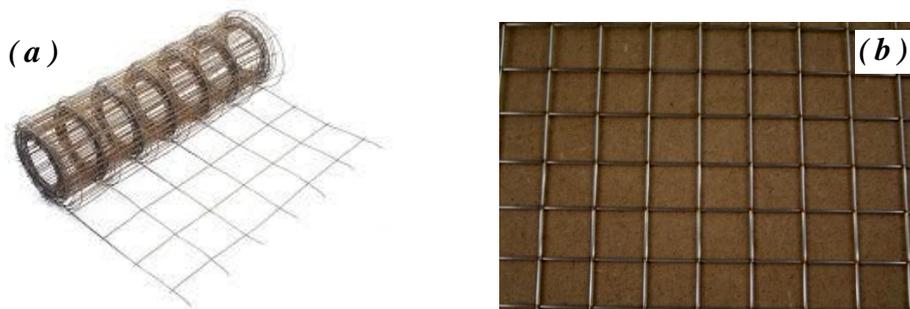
Treillis soudé: (a) en rouleaux; (b) en panneau ou en plaque
